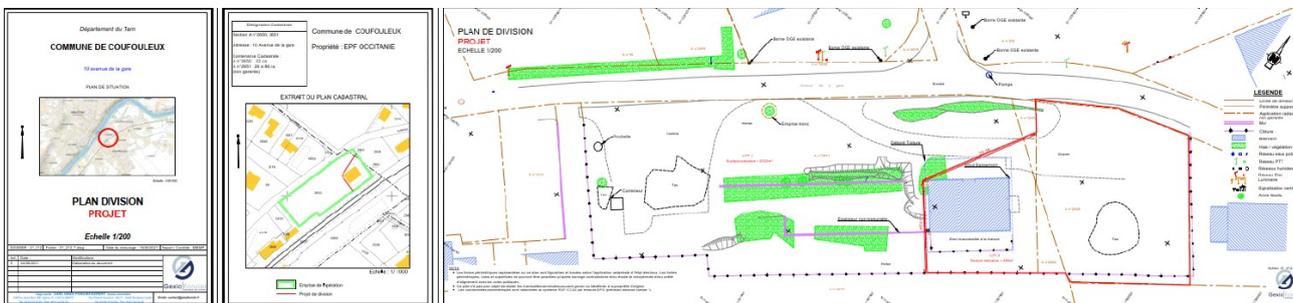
Plan de localisation du site et extrait du plan cadastral (sans échelle) (sources : EPF d'Occitanie)
